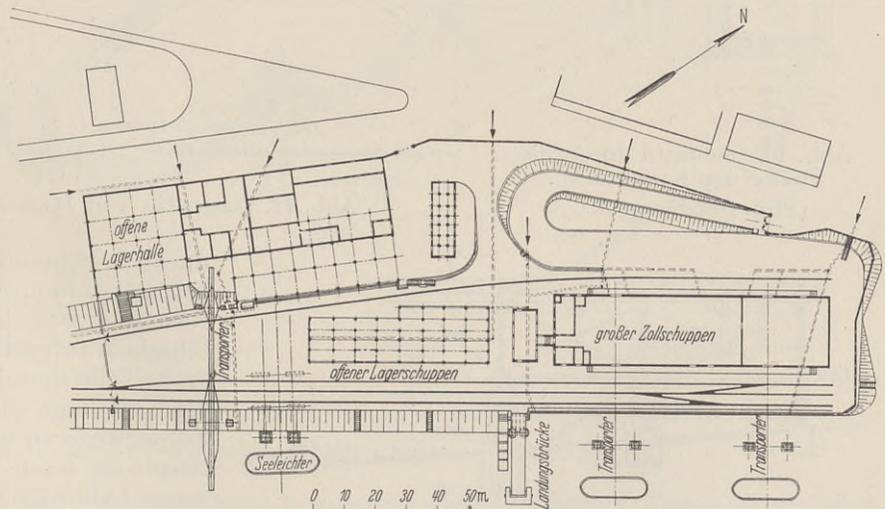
Lageplan der Kaianlagen in Daressalam.
